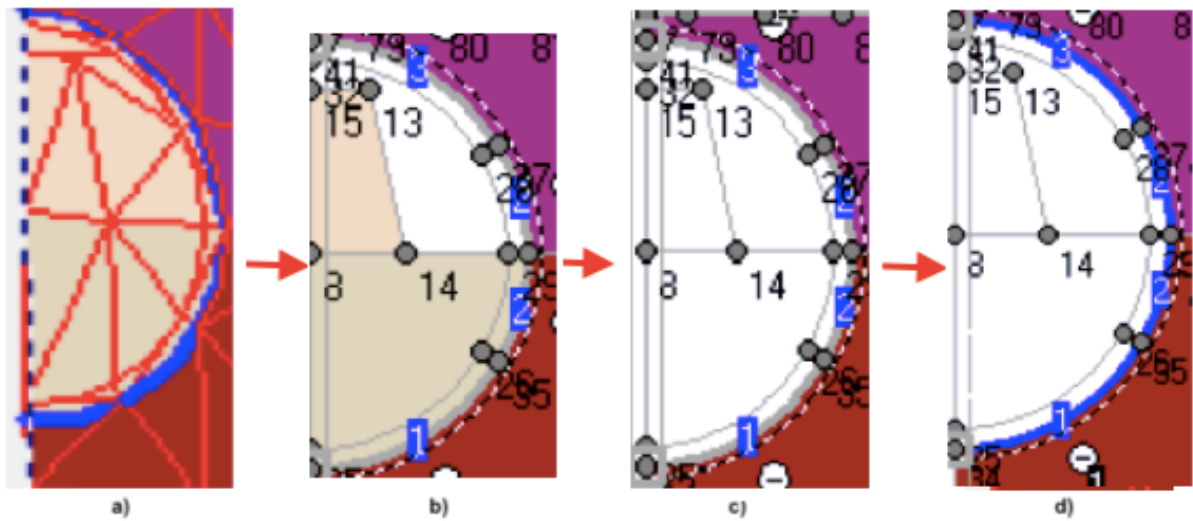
Avanço construtivo simulado: a) seção não escavada; b) escavação da calota; c) escavação do núcleo e da bancada e d) ativação dos elementos de concreto projetado
